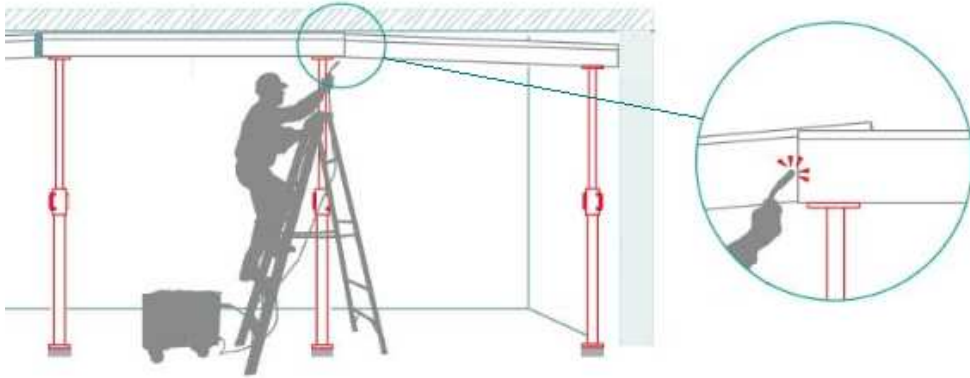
Soldadura del elemento lineal. Fuente: <http://goo.gl/7XlgiY> (04/06/2015; 17:51)
